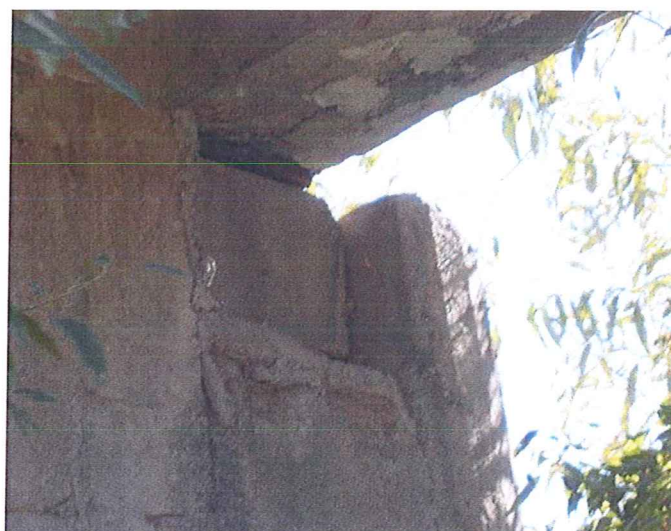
Aparat de reazem mobil pe pilă (pendul)
